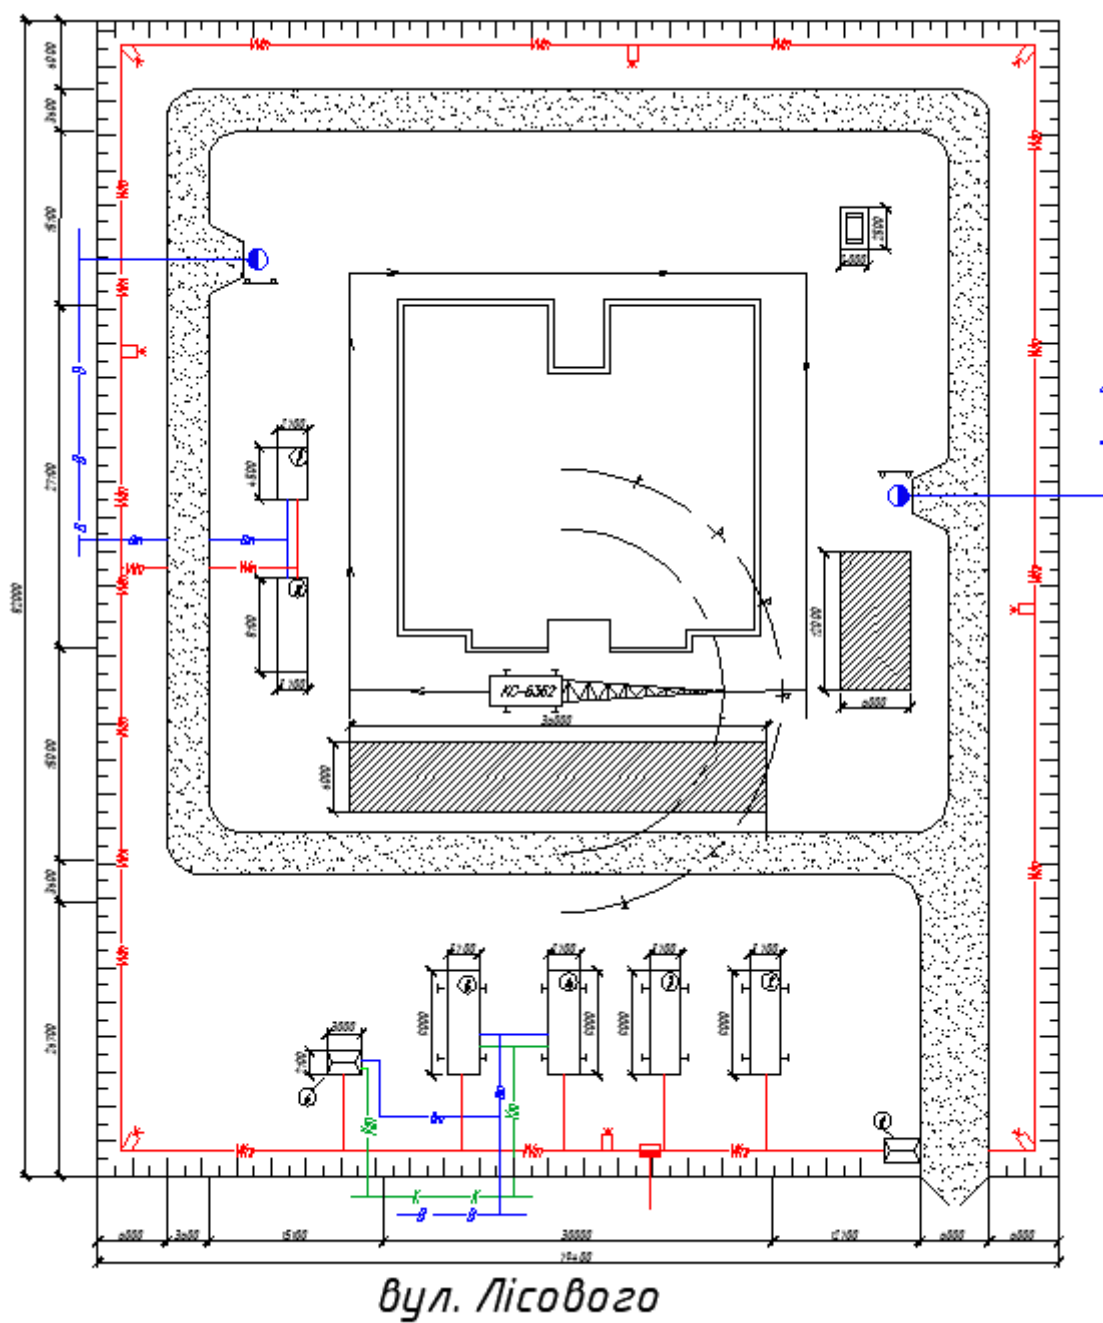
Схема генерального плану будівельного майданчику
